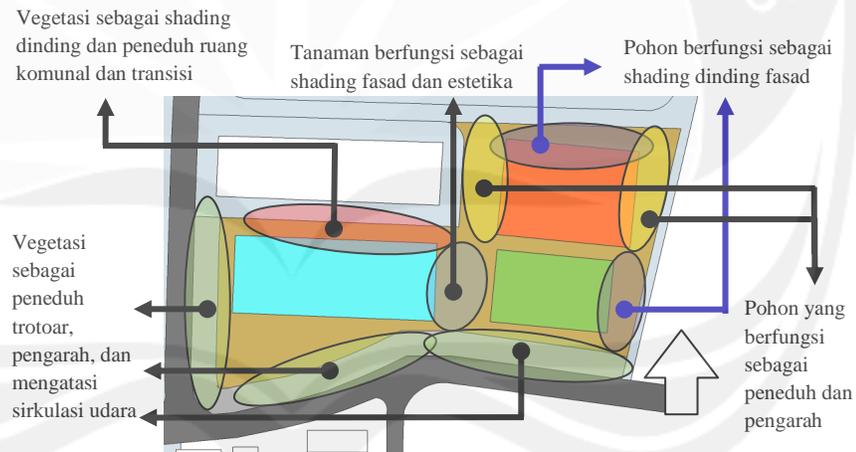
Konsep Tata Bangunan dan Ruang
